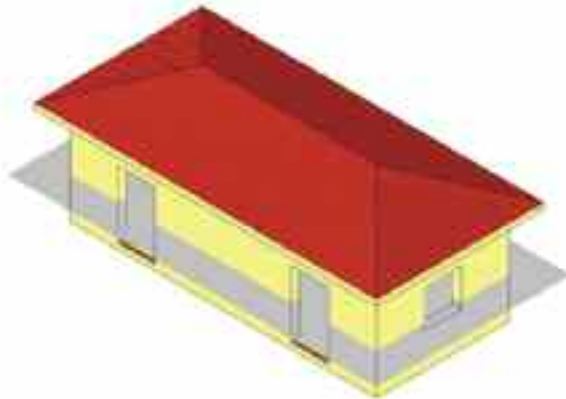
sezionamento con piano orizzontale ideale posto ad 1,20 m dal piano di calpestio
